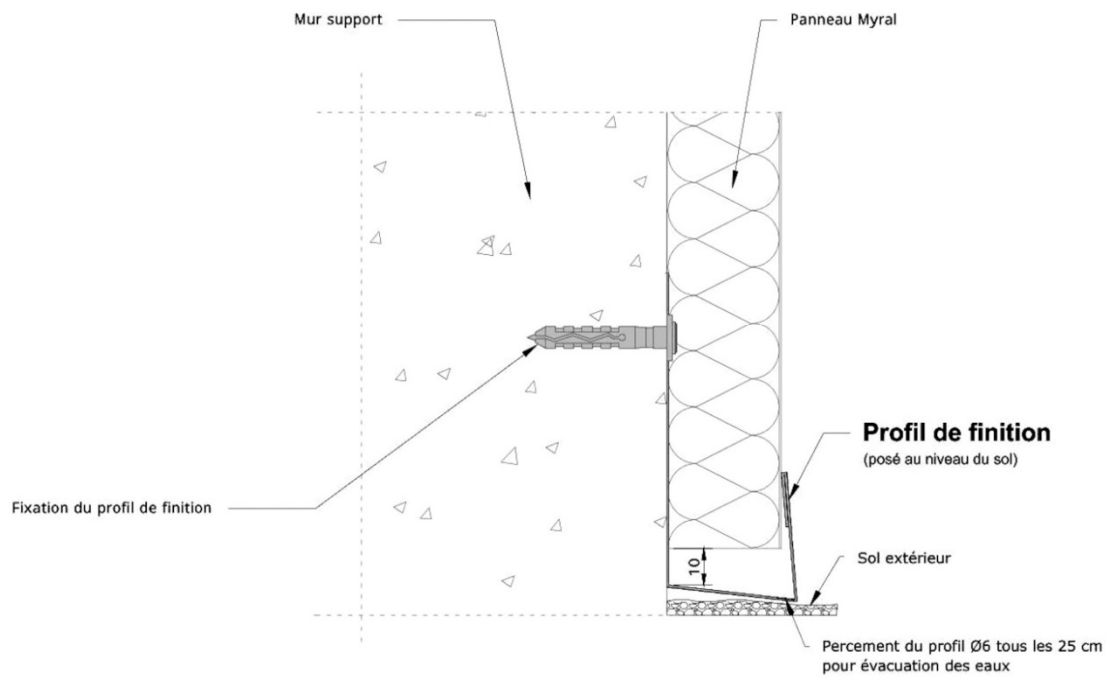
Bas de façade – Pose en vêtire (coupe verticale)
